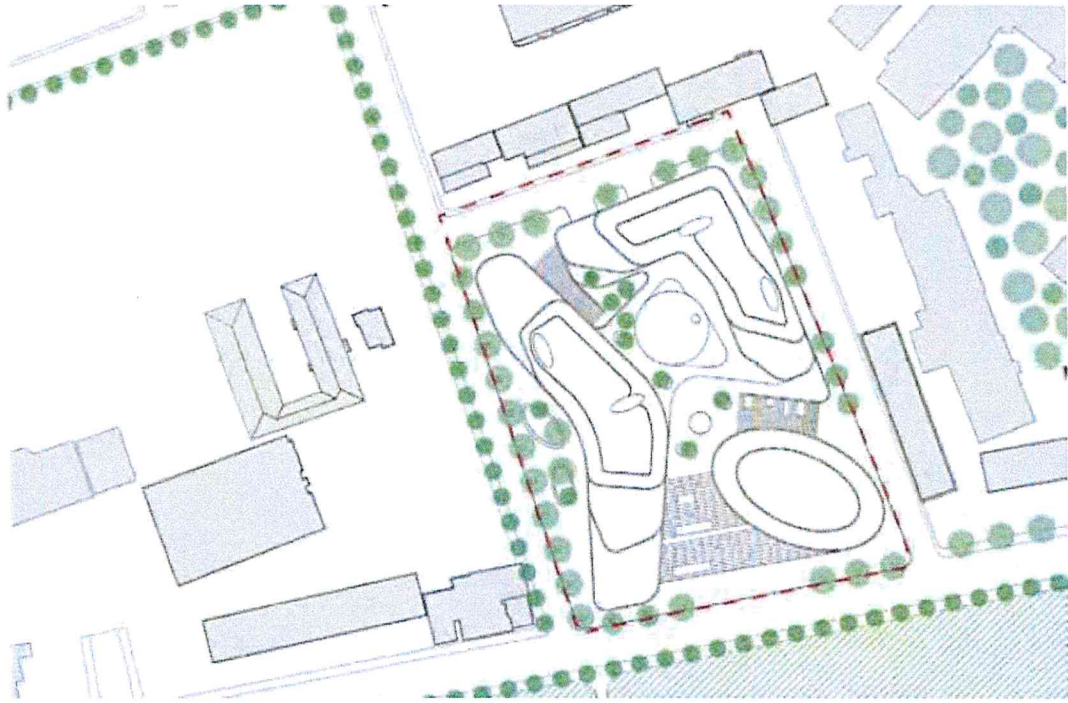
Planvendosje skematike e “Tirana Gjergj Fishta Boulevard Residential Complex”
